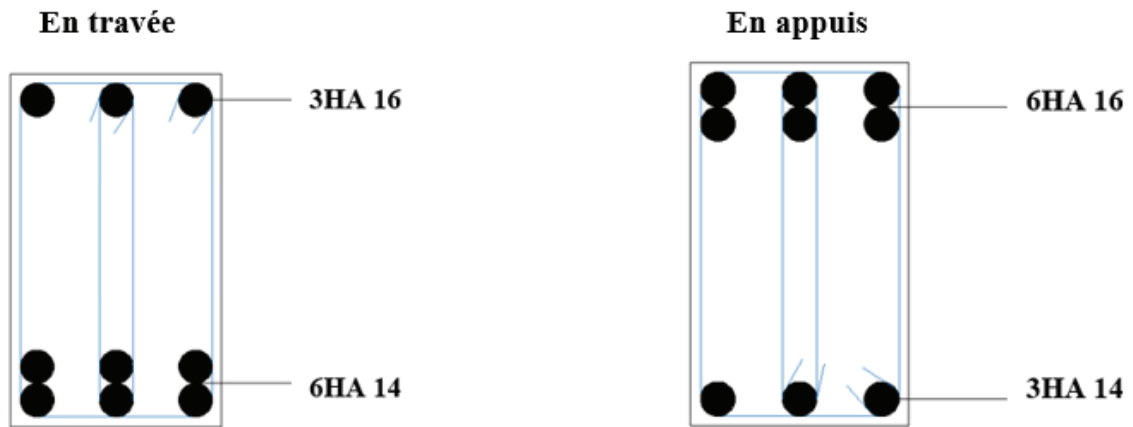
Schéma ferrailage des poutres longitudinales 50 x 30.
